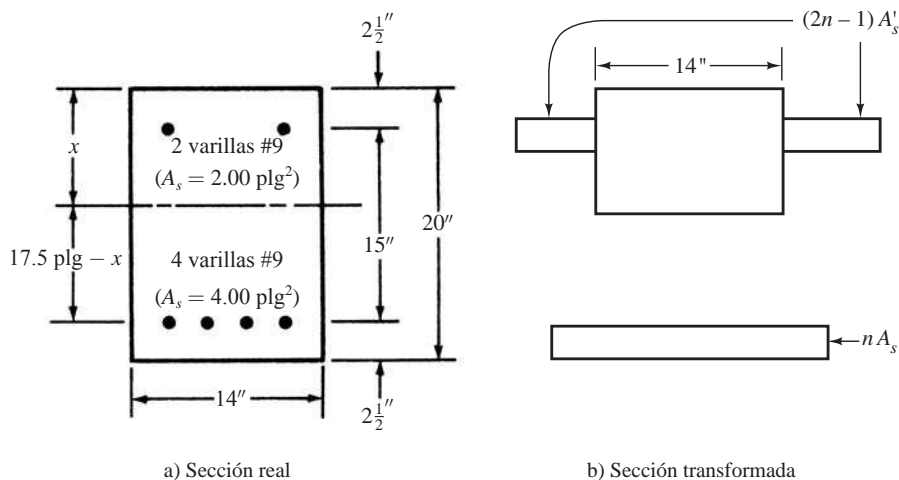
Sección transversal de la viga del Ejemplo 2.7.
